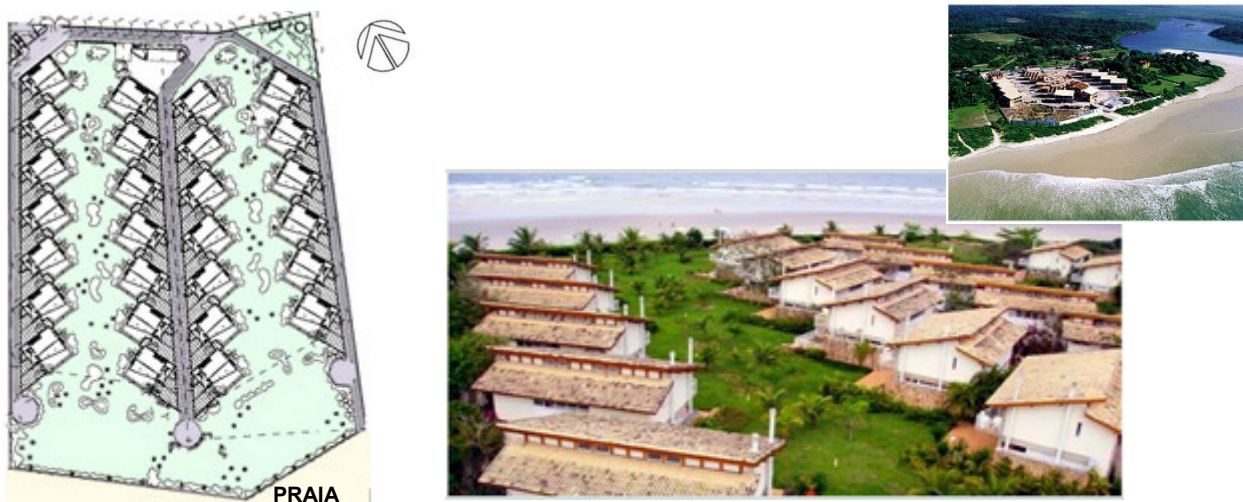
Implantação, vista aérea e fotos externas do projeto Pontal de Guaratuba (H-04).
